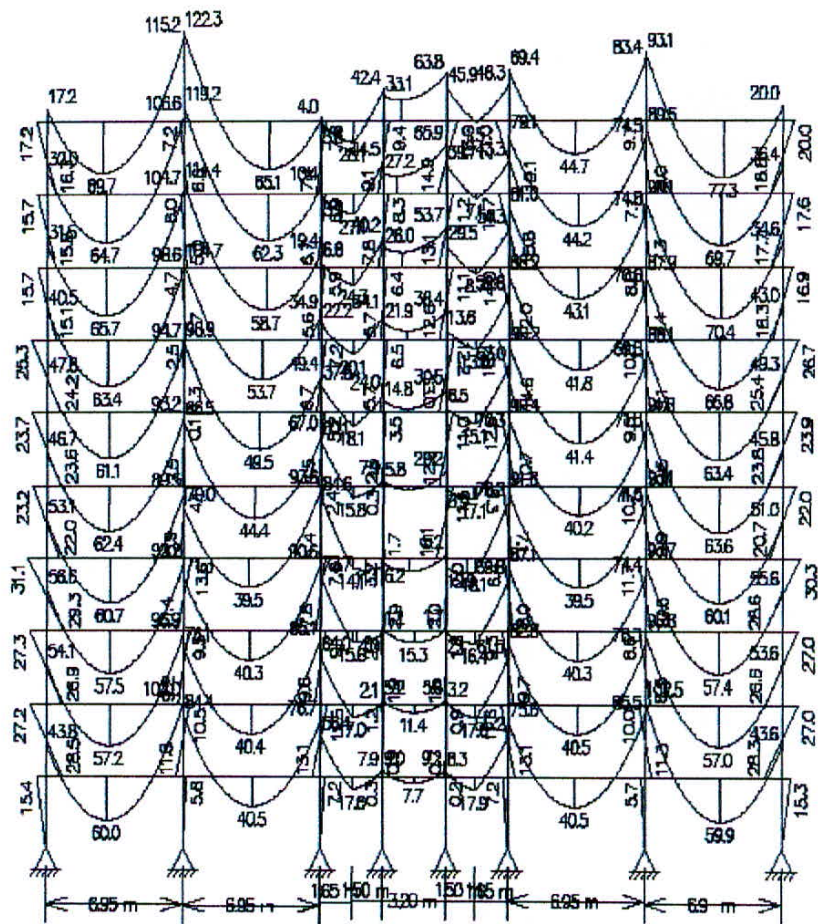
Pórtico P1 Longitudinal, D.M.F.
